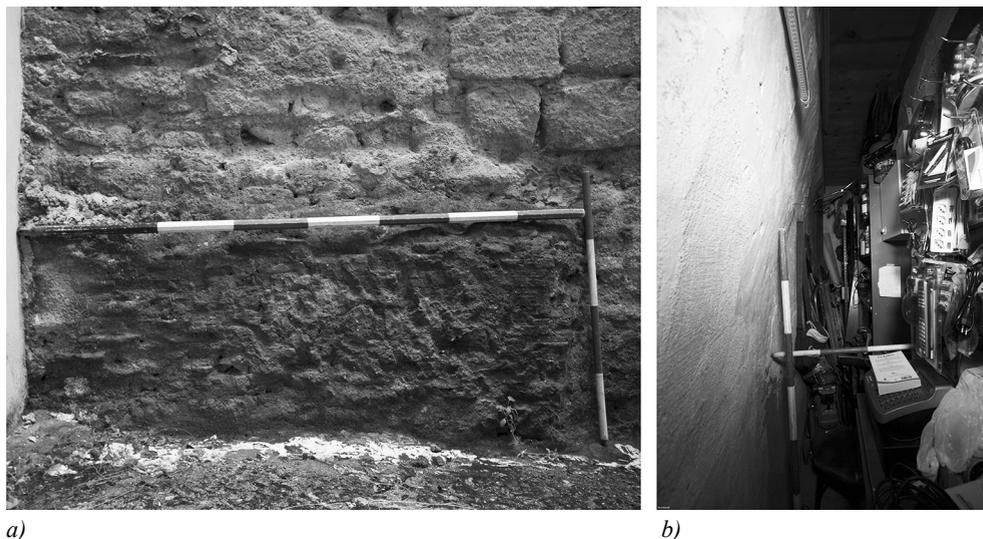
Palazzo Traetto canale est: a) parete esterna; b) speco riutilizzato come laboratorio..
